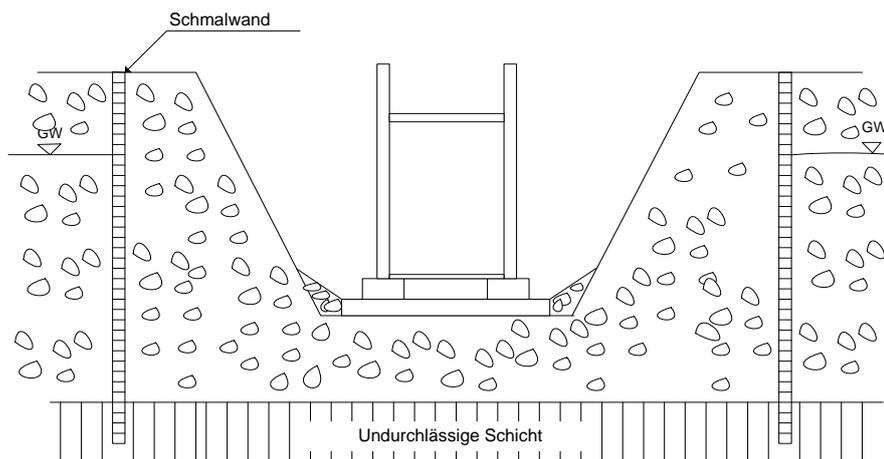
Schmalwand zur temporären wasserdichten Abschottung von Baugruben [1]
